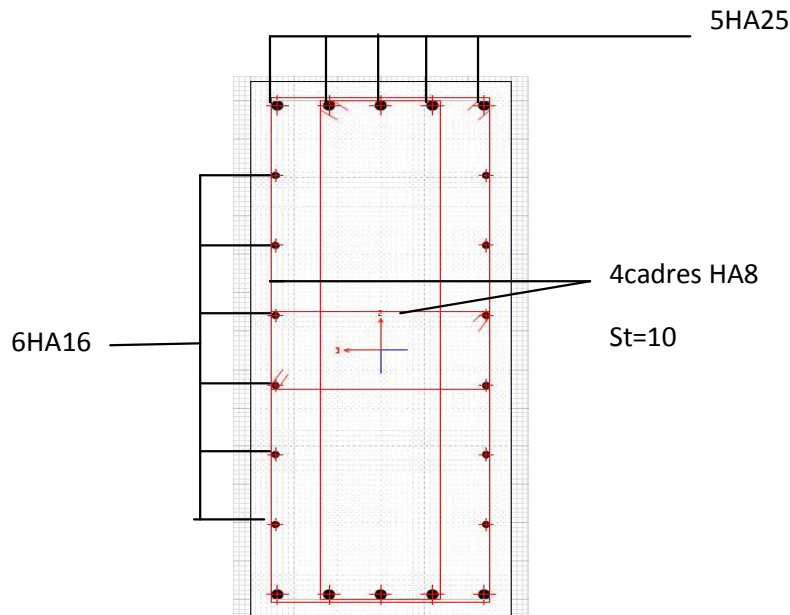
schéma du ferrailage longitudinal et transversal du poteau de section 60x140cm².
